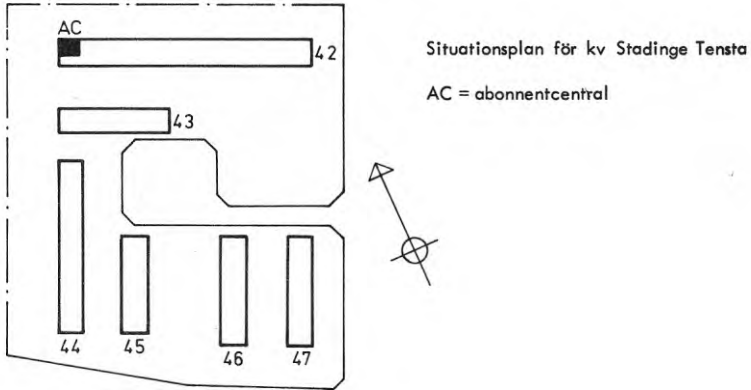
Situationsplan för kv. Stadinge, Tensta.
